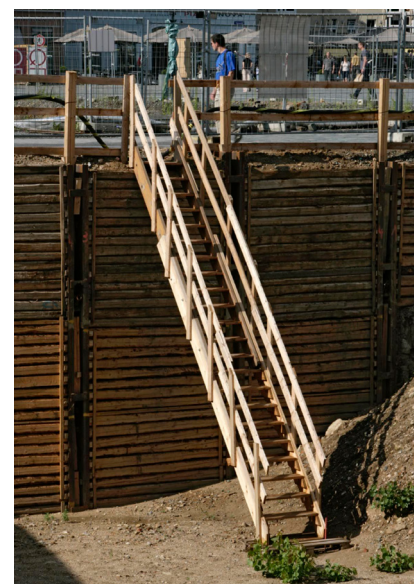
Bautreppe als Zugang zu einer Baugrube
